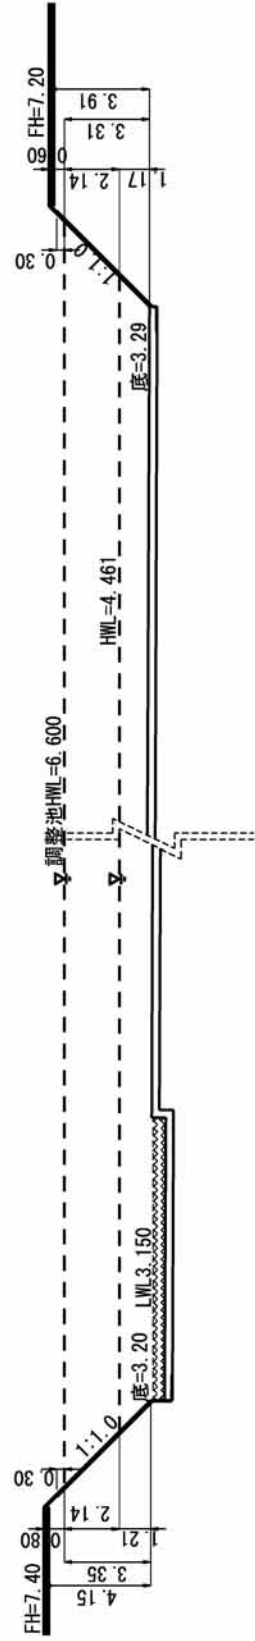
(3) 調整池計画平面・断面図 (第1調整池) 【第3回変更】
